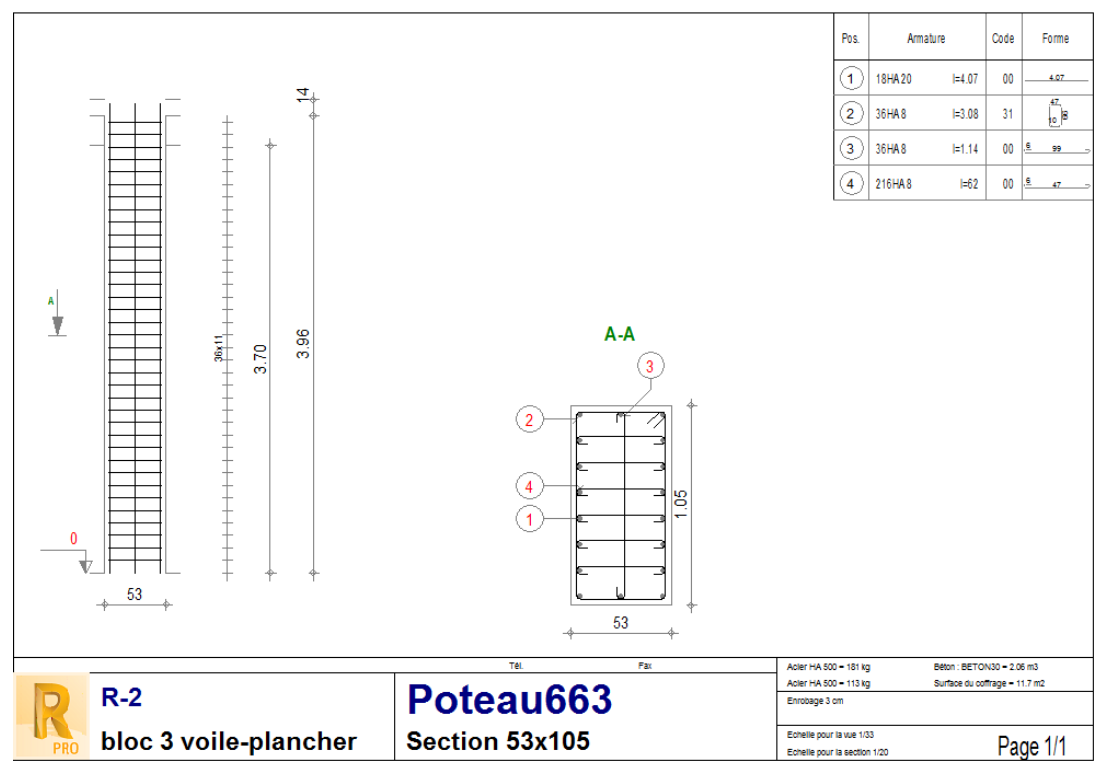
Ferrailage des poteaux P49, P50 et P51 (R-2)
